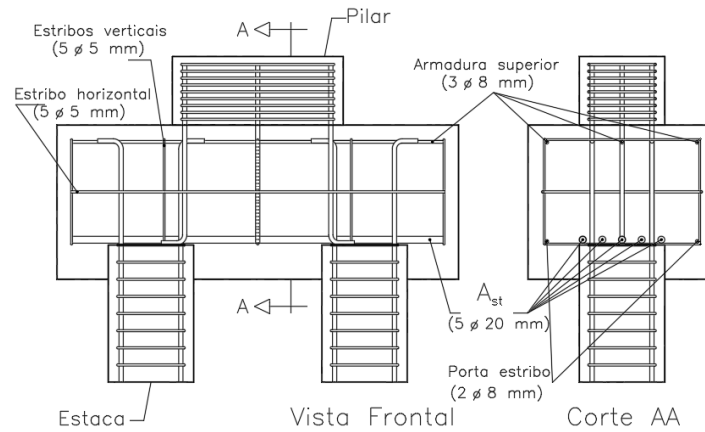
Detalhe esquemático das armaduras dos modelos B45Emb5.5
